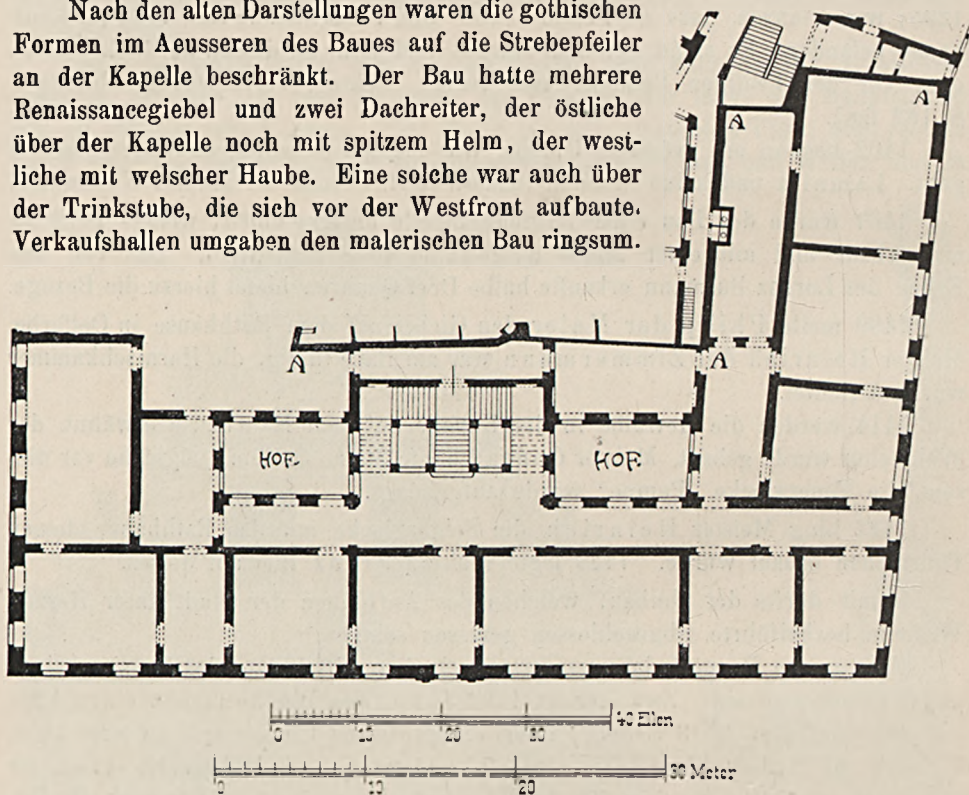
Das ältere Gewandhaus; Grundriss des Obergeschosses.
